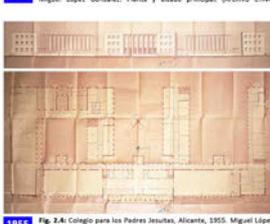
Colegio para los Padres Jesuitas, Alicante, 1955. Miguel López. Planta baja y alzado principal. Archivo Histórico Municipal Alicante.
